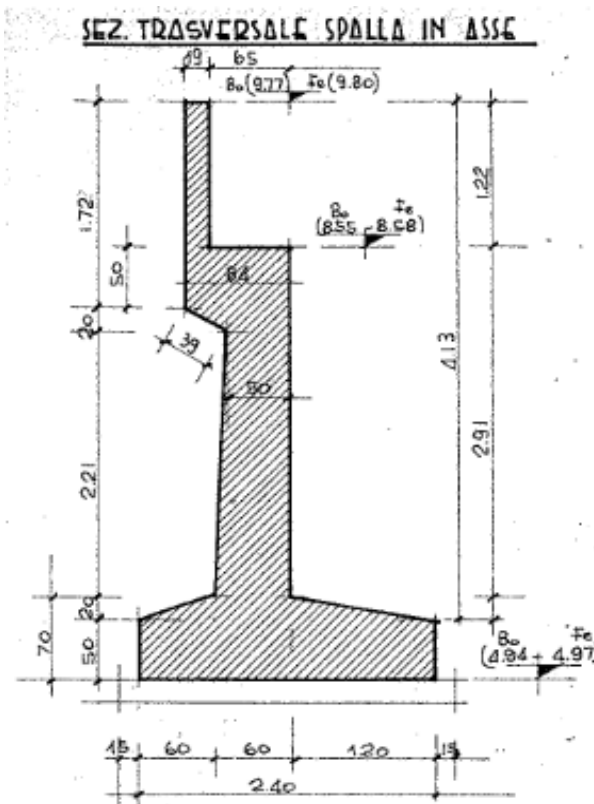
Sezione trasversale spalla esistente
